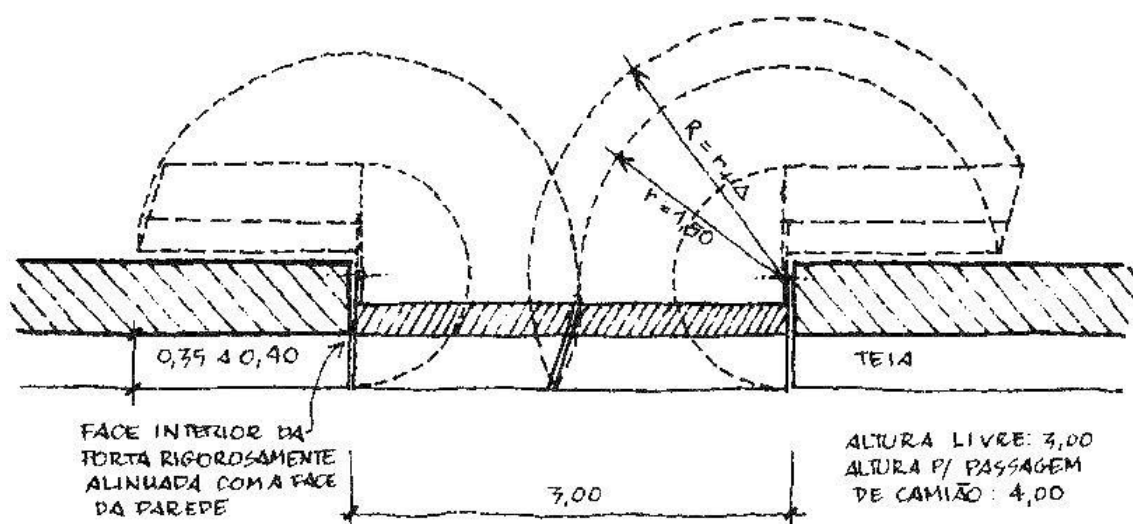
Exemplo – porta principal do picadeiro (Planta)
